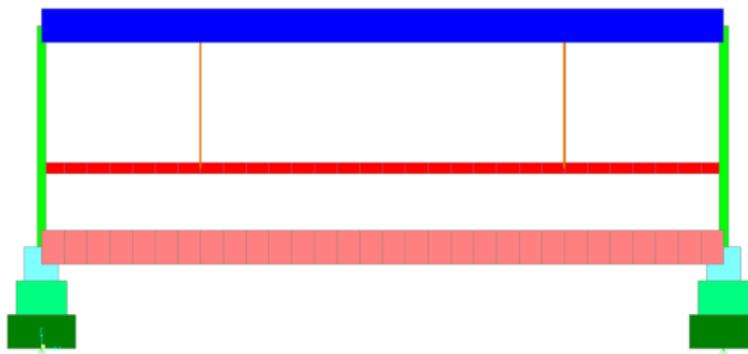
Vista do Modelo SAP com a laje da sobreloja (Fonte: Autora)
